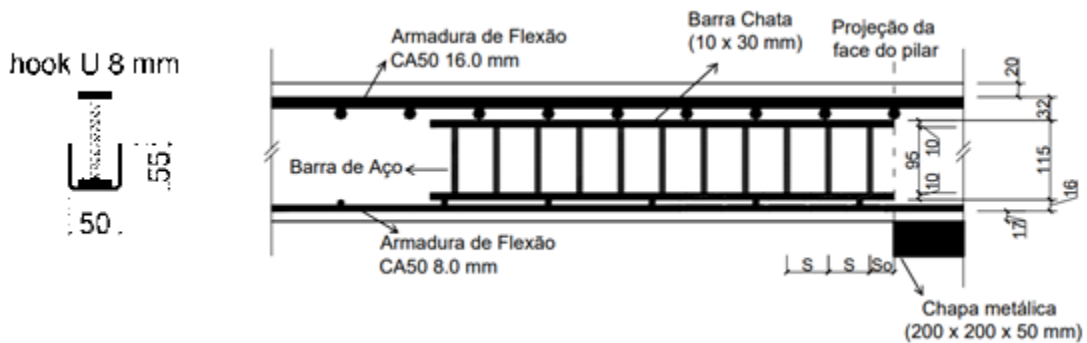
Esquemático com a posição da armadura (Adaptado de Trautwein, 2006)
